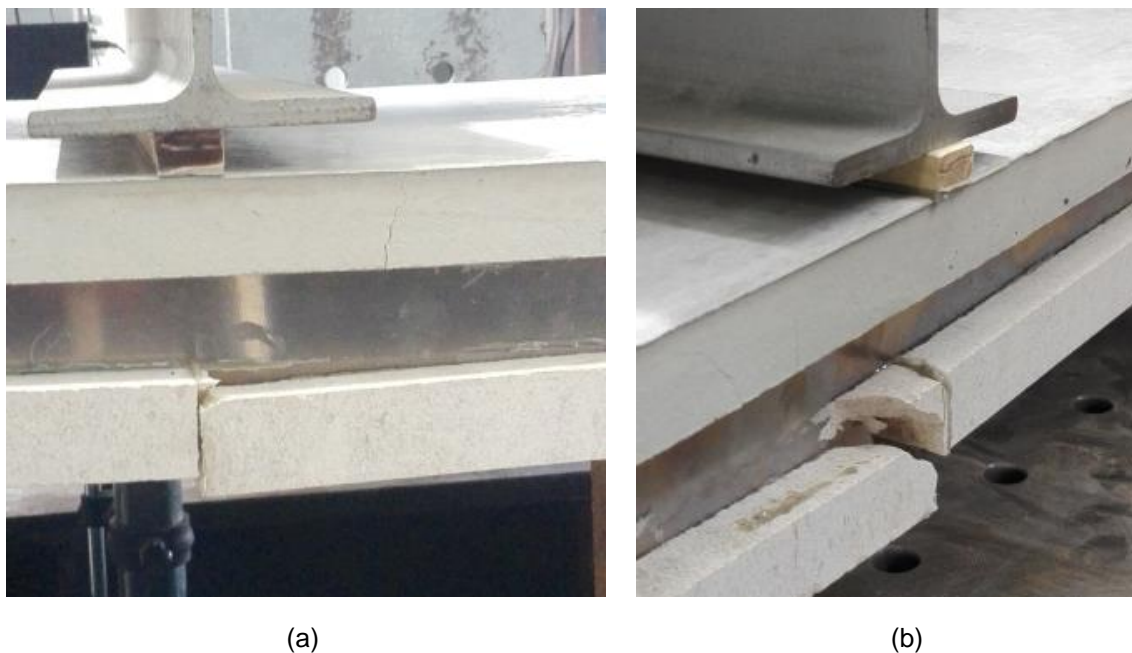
Rotura da pedra por corte na secção de colagem
